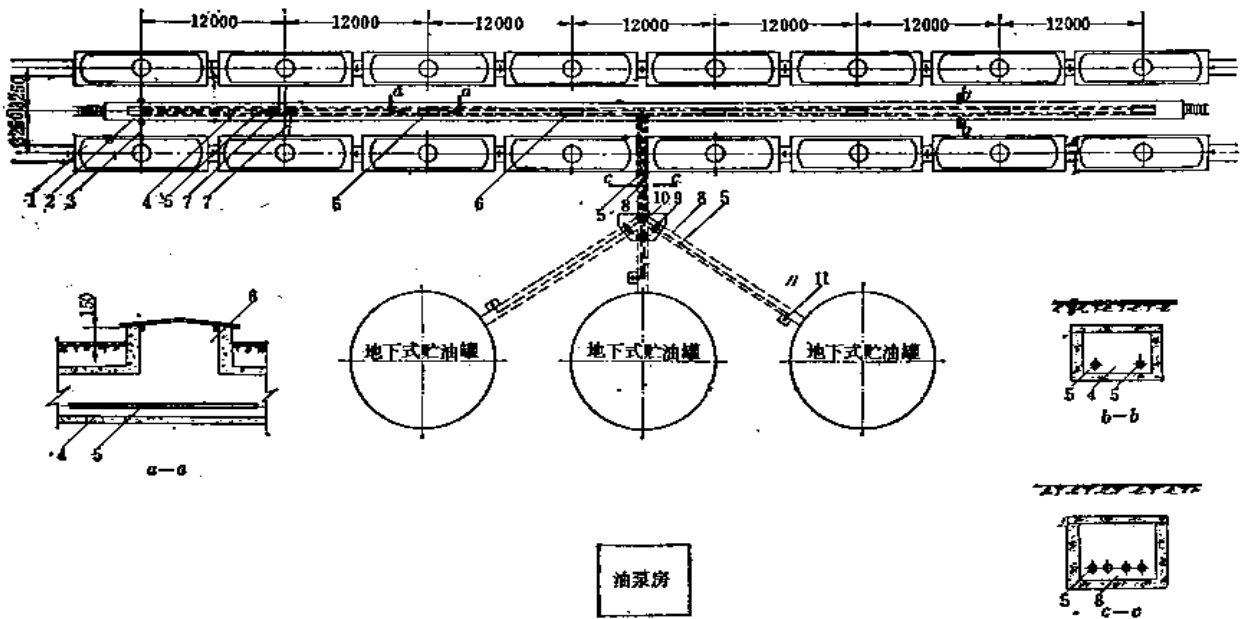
短管下卸（敞开式）设施（双侧）平面布置图
